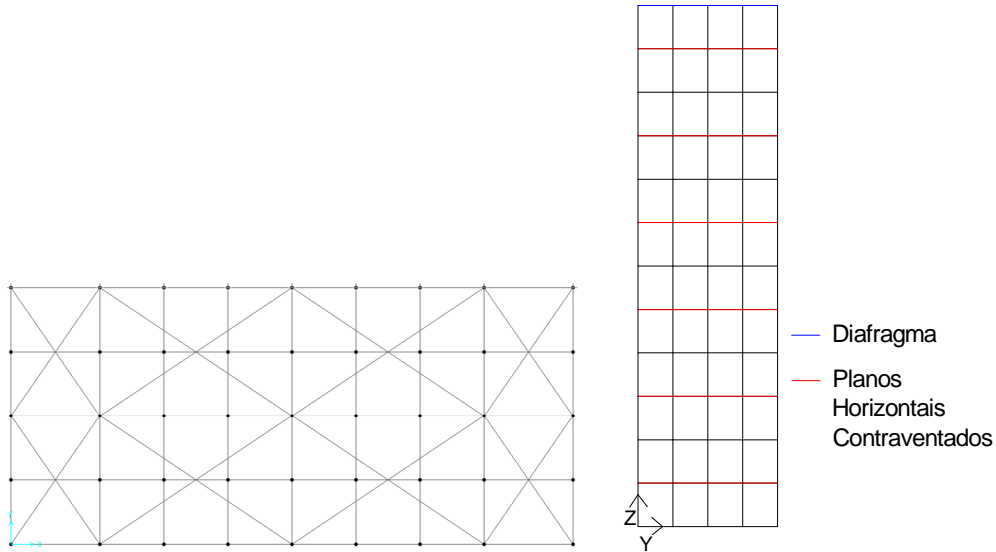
Configuração dos Planos de Contraventamento Horizontal Com Elementos de Contraventamento Grandes
